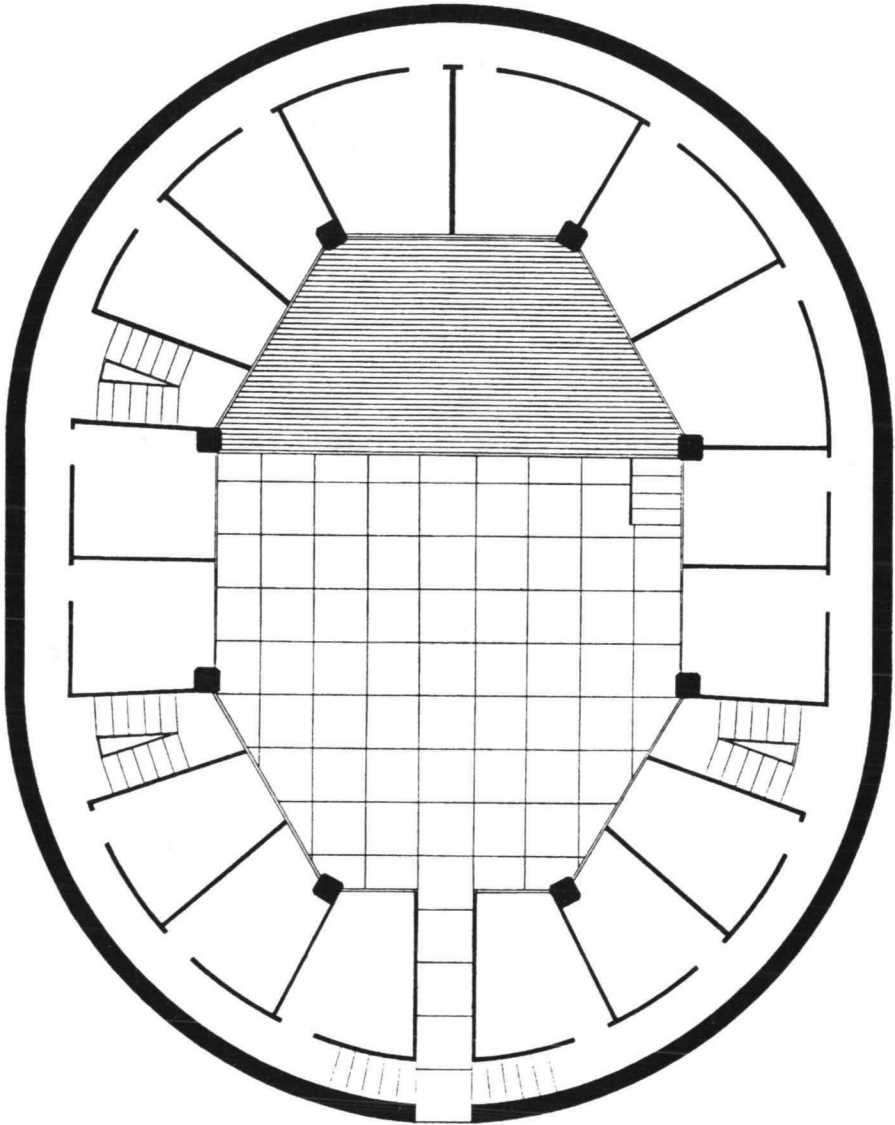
Reconstrucción ideal de la planta baja del patio de comedias de Calaborra.
